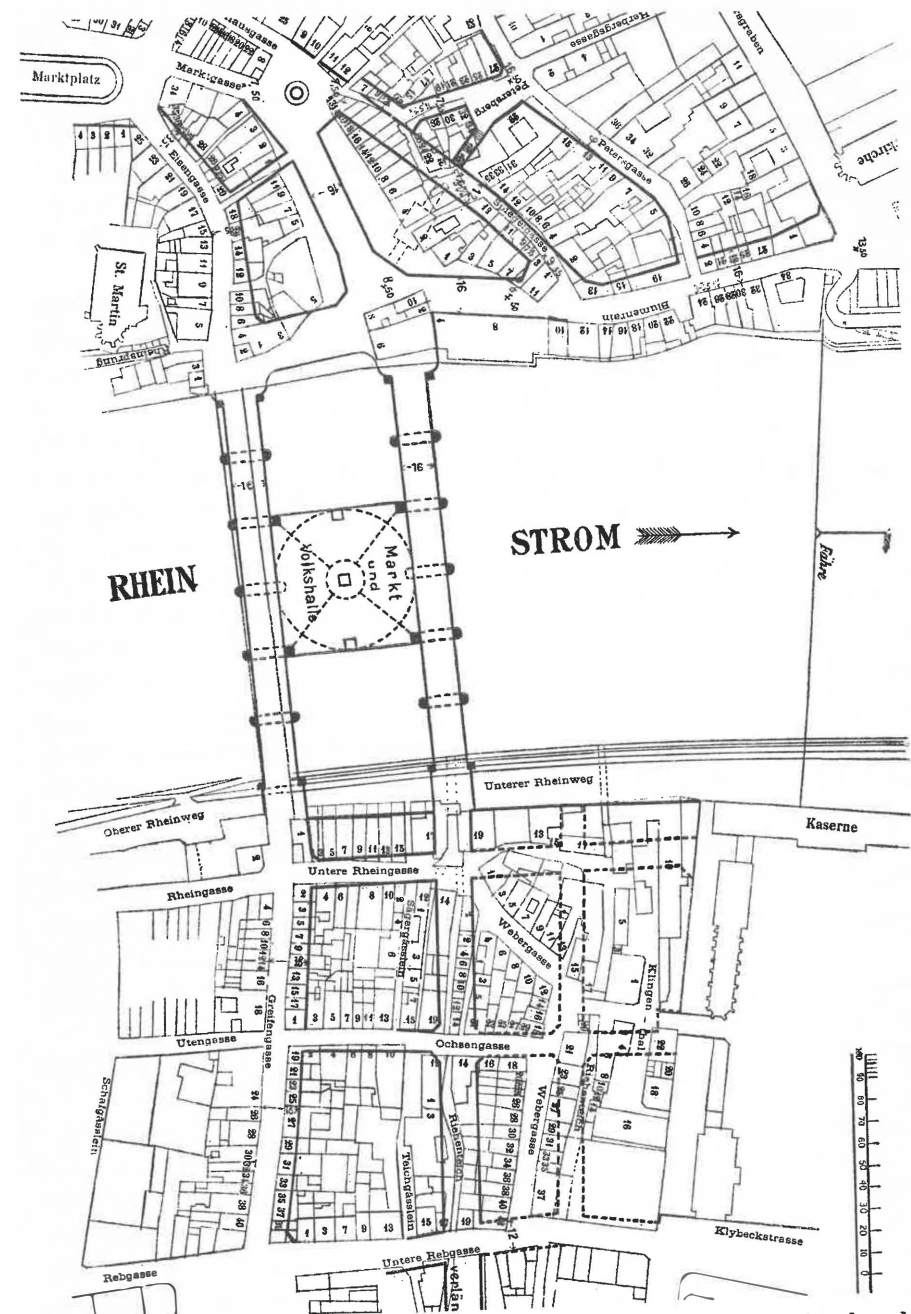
Strassenkorrekturen für Basel-Stadt 1899 im Zuge einer Brückenplanung mit Markt- und Volkshalle.
